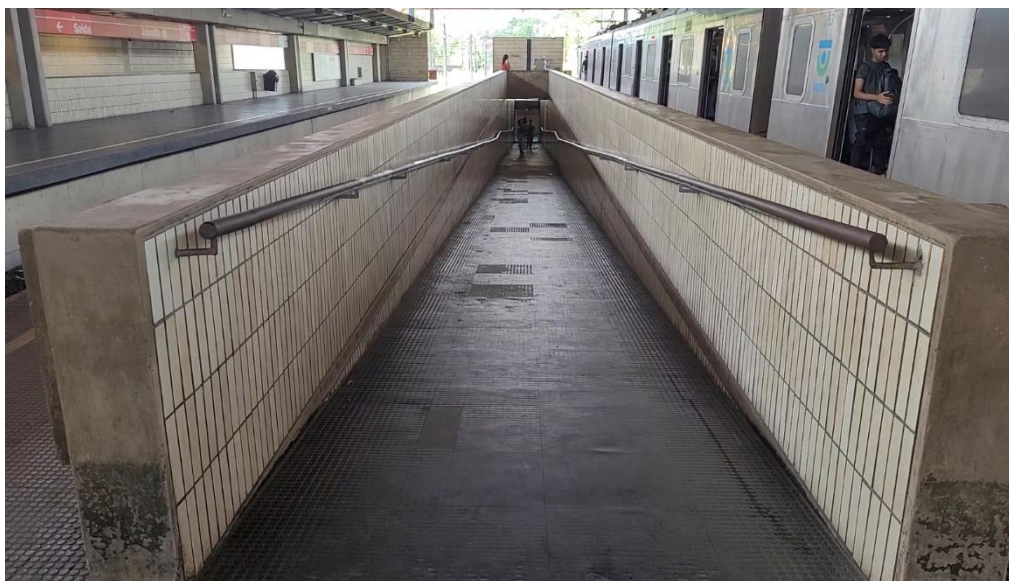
Vista de uma das rampas de acesso à plataforma
